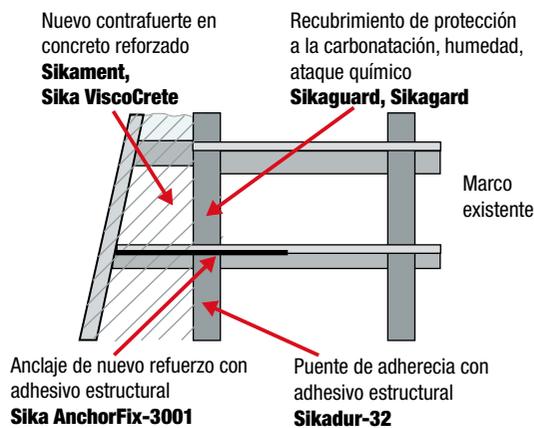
Contrafuerte de concreto reforzado adosado a la estructura existente.
